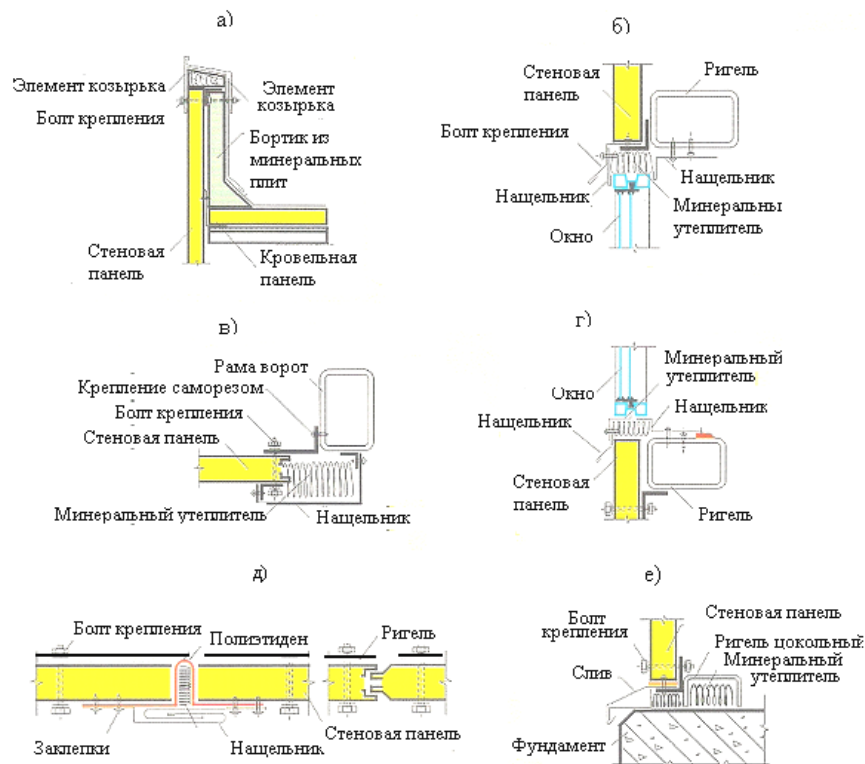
Узлы сопряжения сэндвич панелей с элементами каркаса здания
